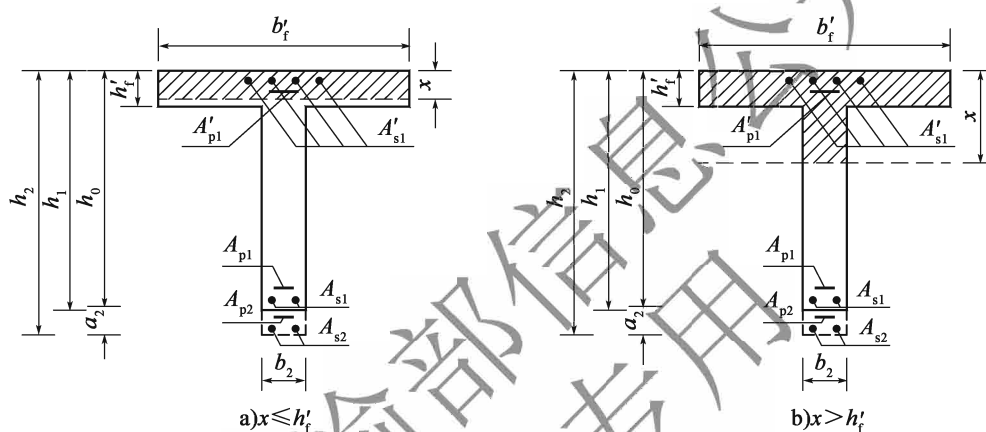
T 形截面混凝土受弯构件增大截面加固正截面抗弯承载力计算
